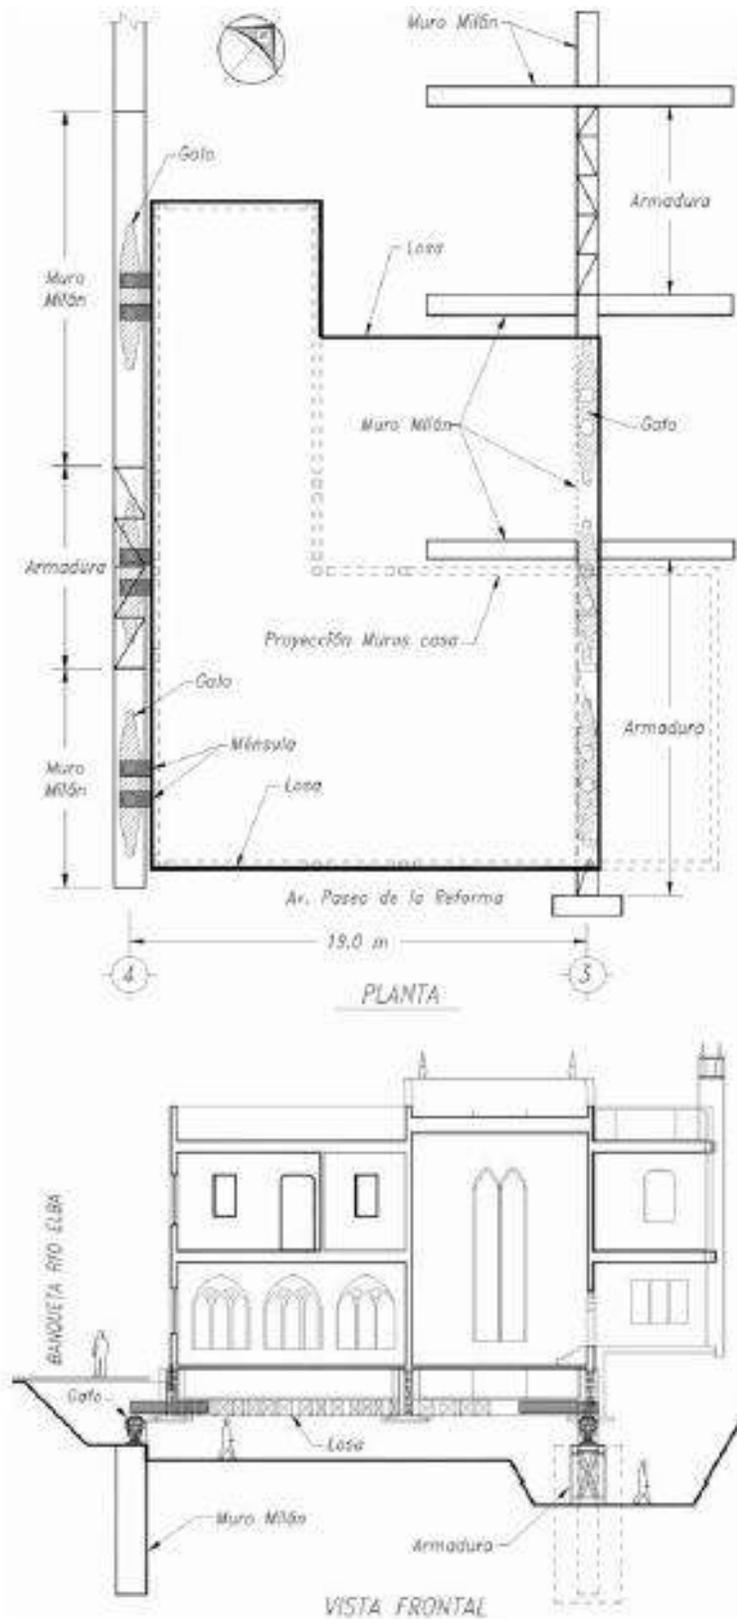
Esquema con la ubicación en planta de la cimentación de apoyo para los rieles durante el movimiento.
